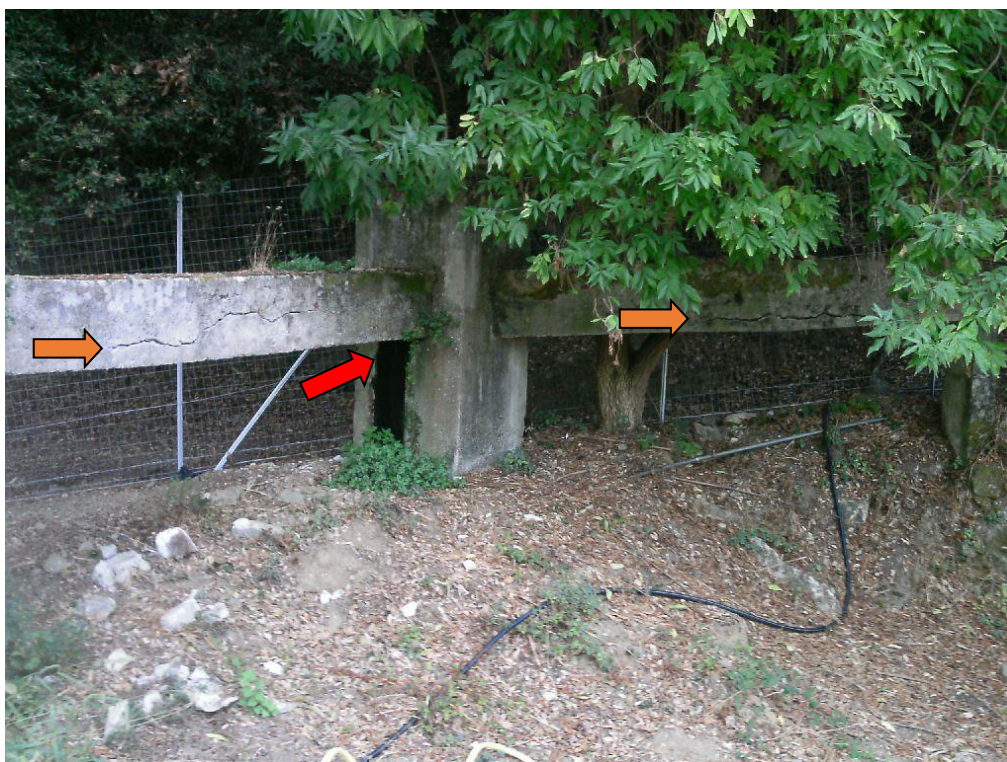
Flèche rouge : présence d'un suintement au niveau du dernier regard surélevé avant dégrilleur. Flèches orange : fissures présentes sur le coffrage des conduites amenant l'effluent à la station.
